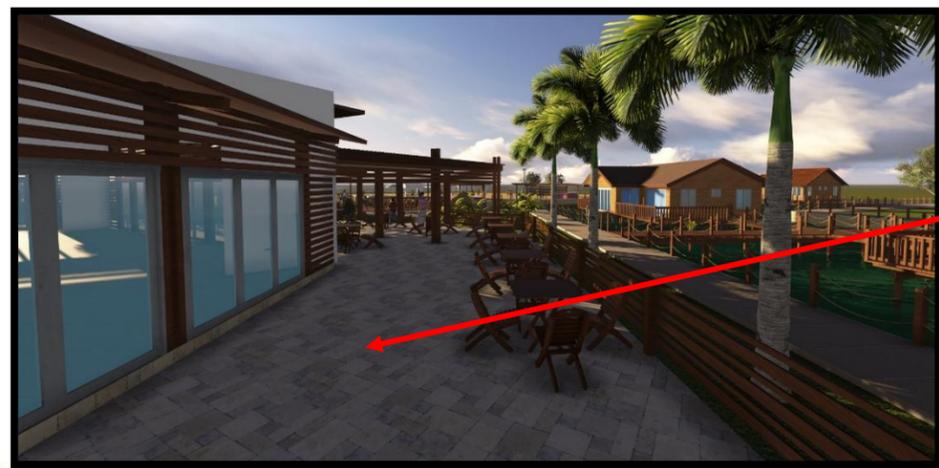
Piso de piedra laja en terraza de Restáurate. Fuente: Elaborado por autores
